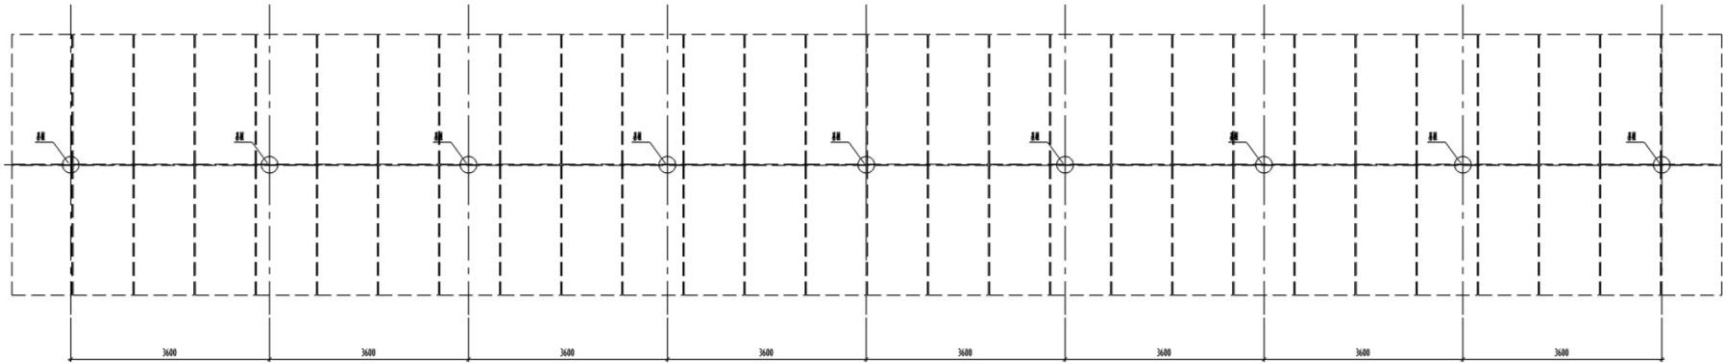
2×28 阵列光伏支架桩基础平面布置示意图
